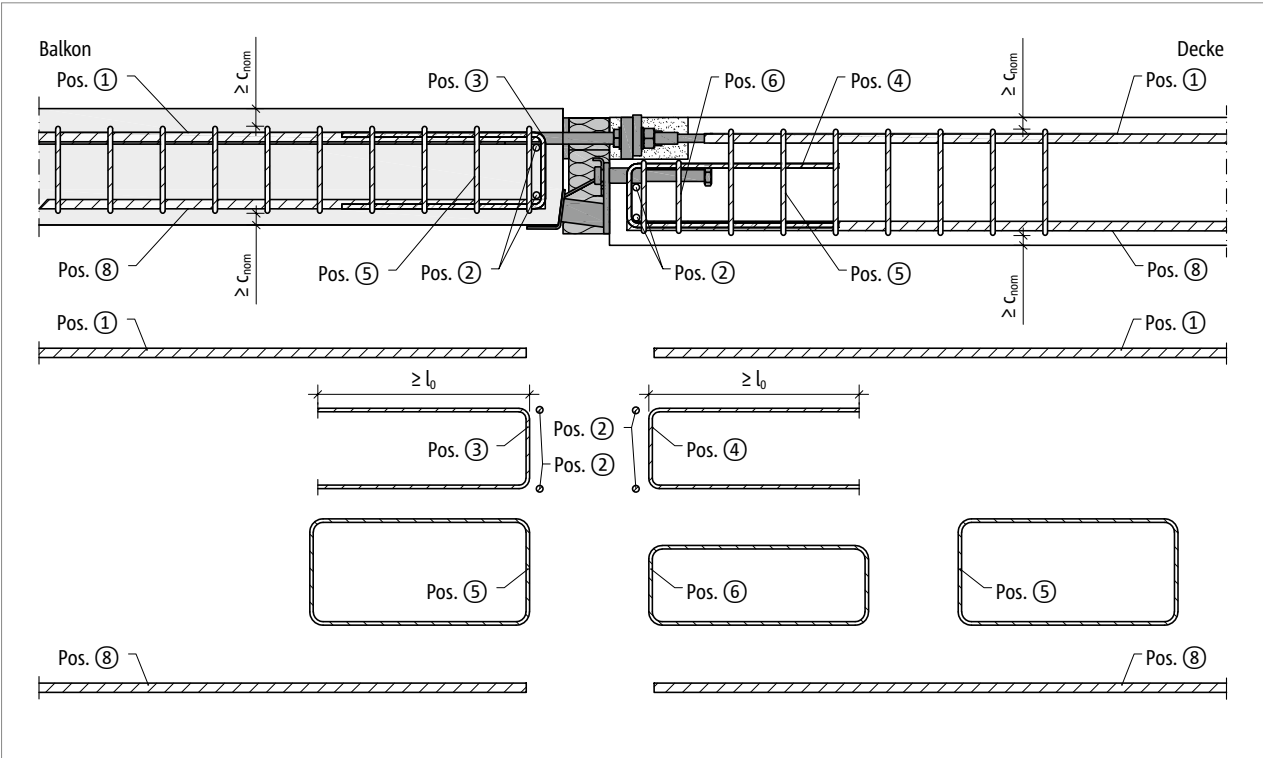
Schöck Isokorb® IQ Typ K-A: Bauseitige Bewehrung
